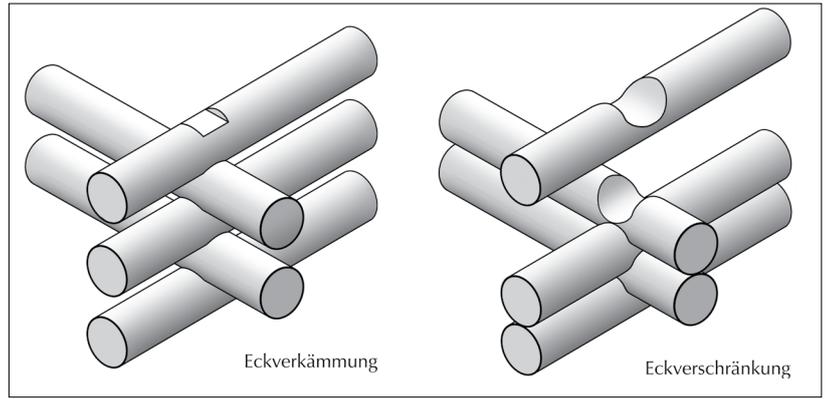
Eckverbindung beim offenen und geschlossenen Rundholzblock mit Vorstoß.
